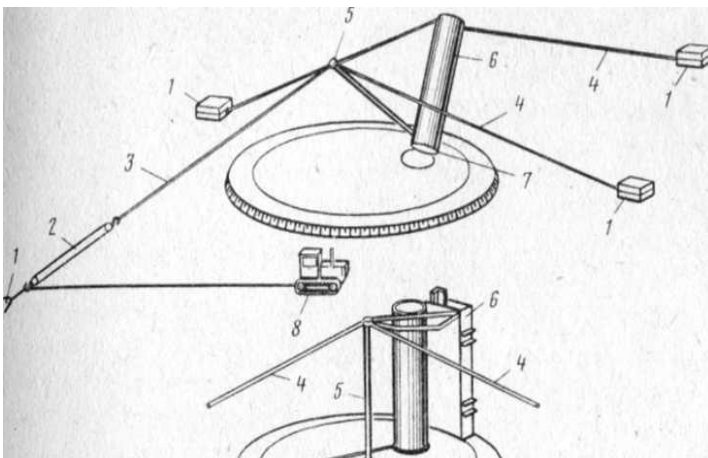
Схема сборки резервуара из рулонных заготовок а – подъем рулона корпуса; б – развертывание рулона
